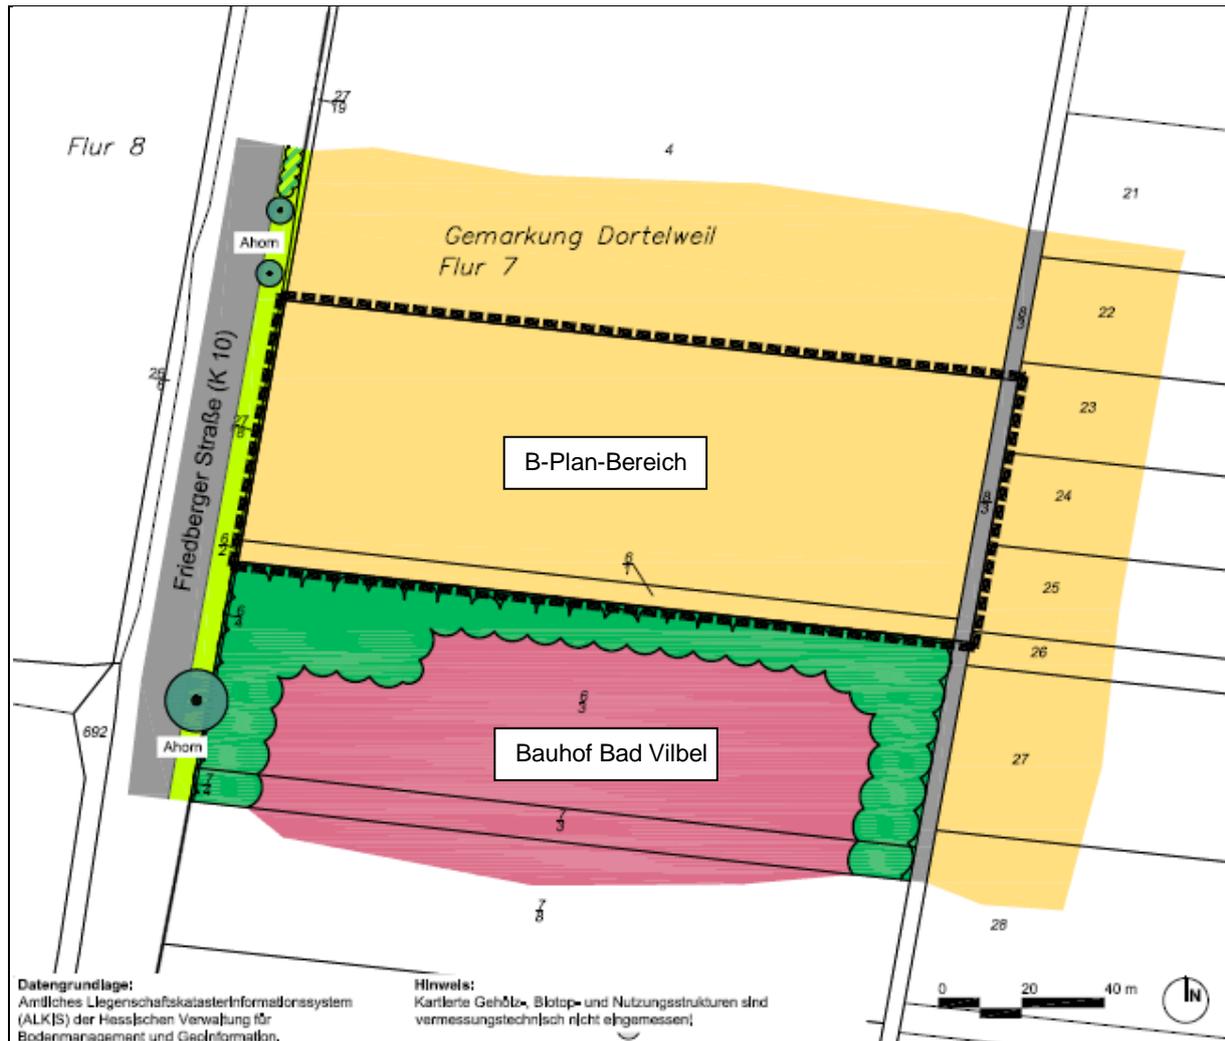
Die Abbildung zeigt die landschaftsplanerische Bestandskarte aus dem Bebauungsplan „Theaterwerkstätten Dortelweil“ vom Planungsbüro DIESING+LEHN mit Stand August 2018. Bei dem B-Plan-Bereich handelt es sich um eine Ackerfläche der Gemarkung Dortelweil.
